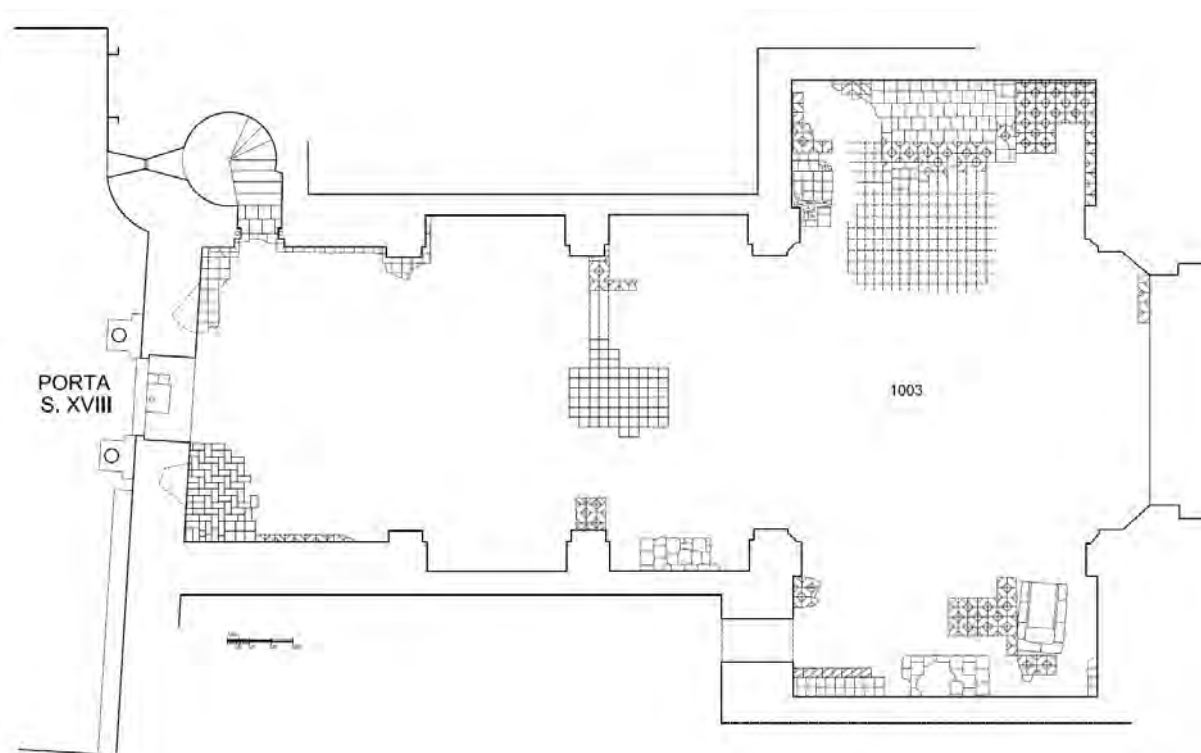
Planta general de l'excavació. Fase 3, paviments d'acabat. Segle XVIII.
